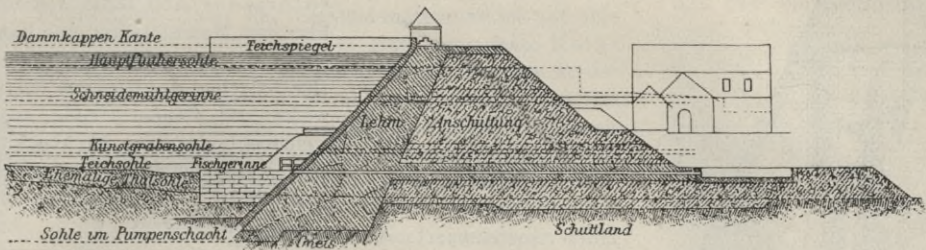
Querschnitt des Dörntaler-Dammes. 1:1000.
